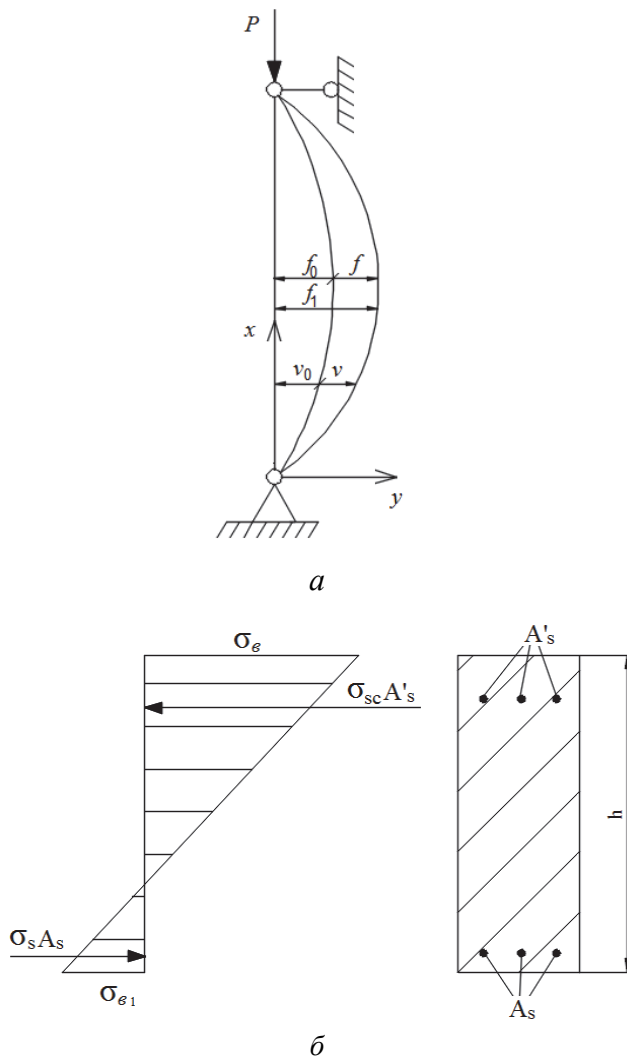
Упругая либо упруговязкая колонна с начальной погибью: *a* – расчетная схема; *б* – поперечное сечение, неограниченные напряжения в бетоне и арматуре – трещины отсутствуют
